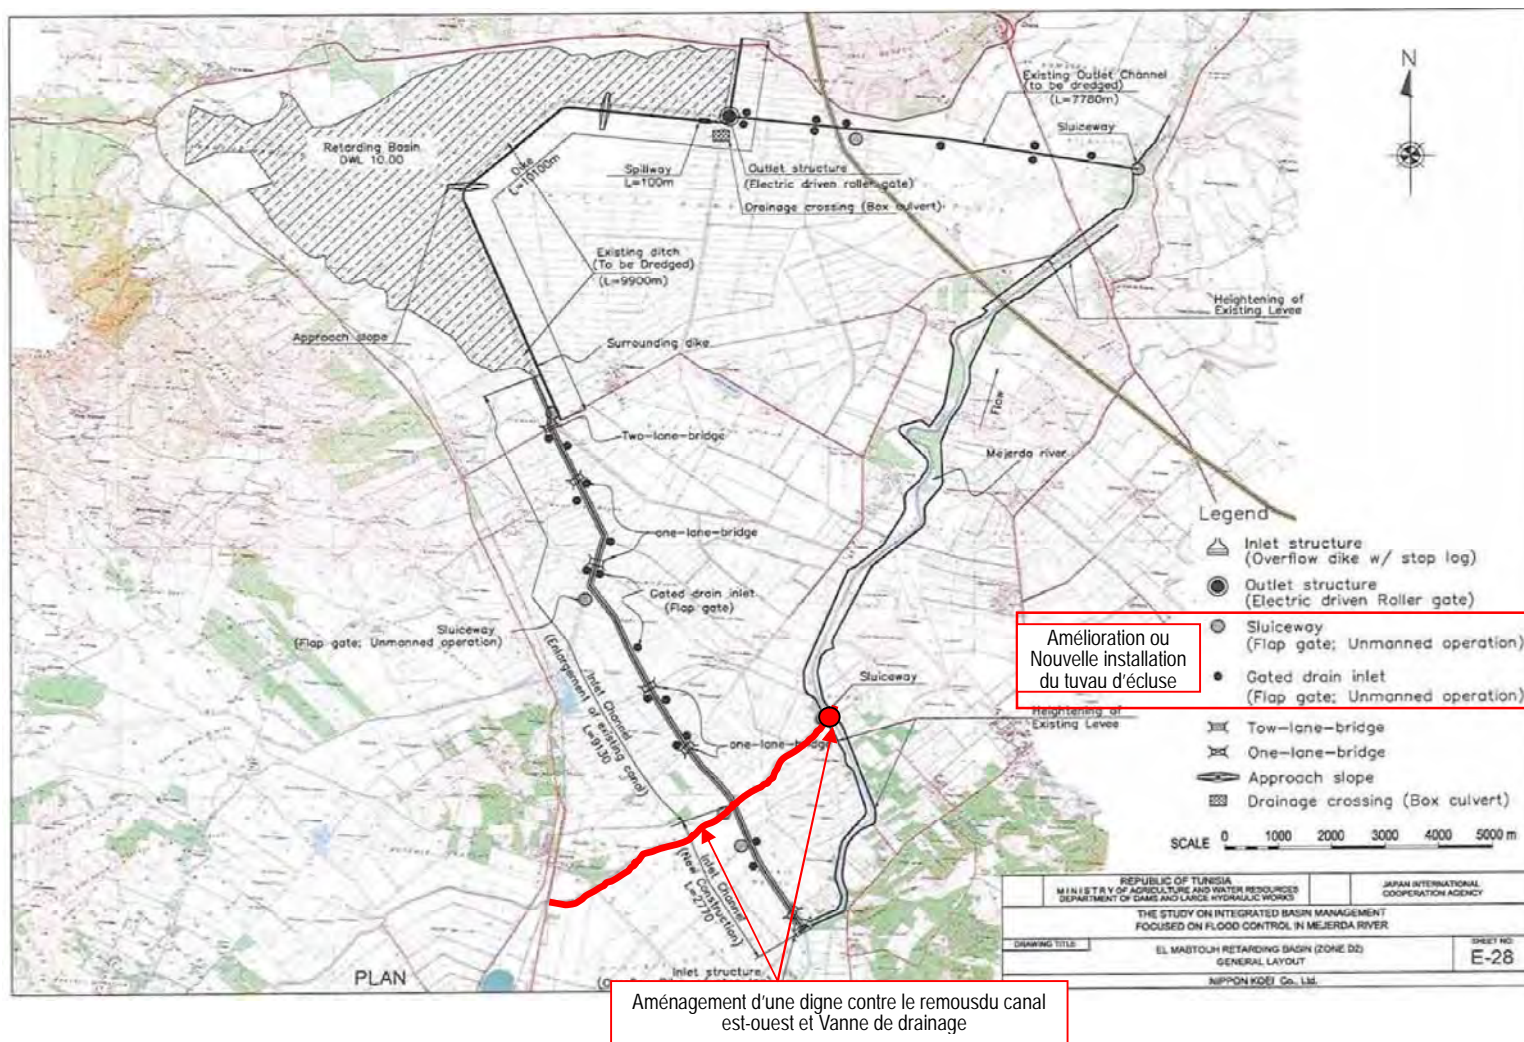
Plan de situation d'autres ouvrages connexes
